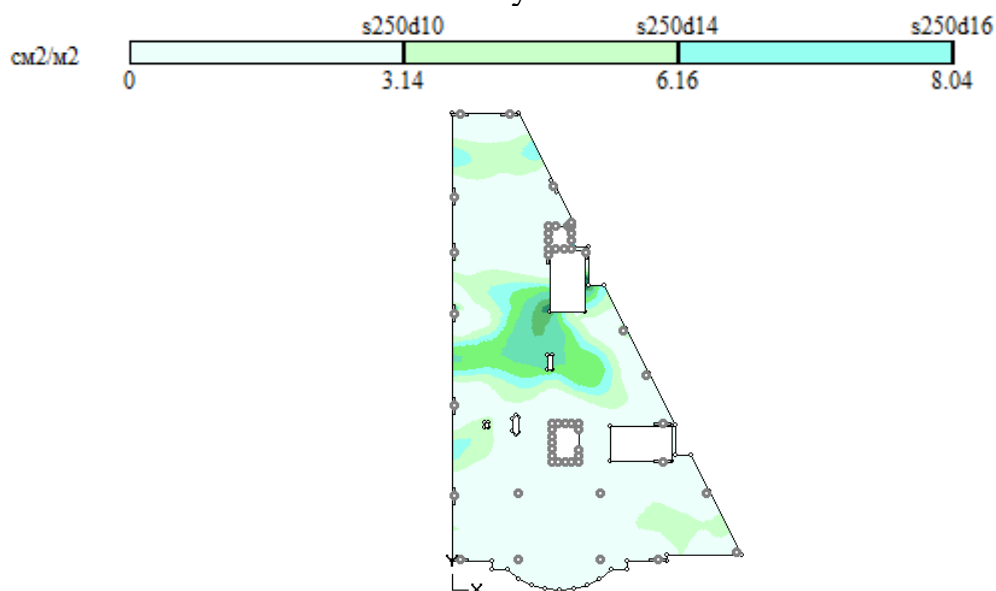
Схема розташування нижньої арматури вздовж буквених осей у плиті
